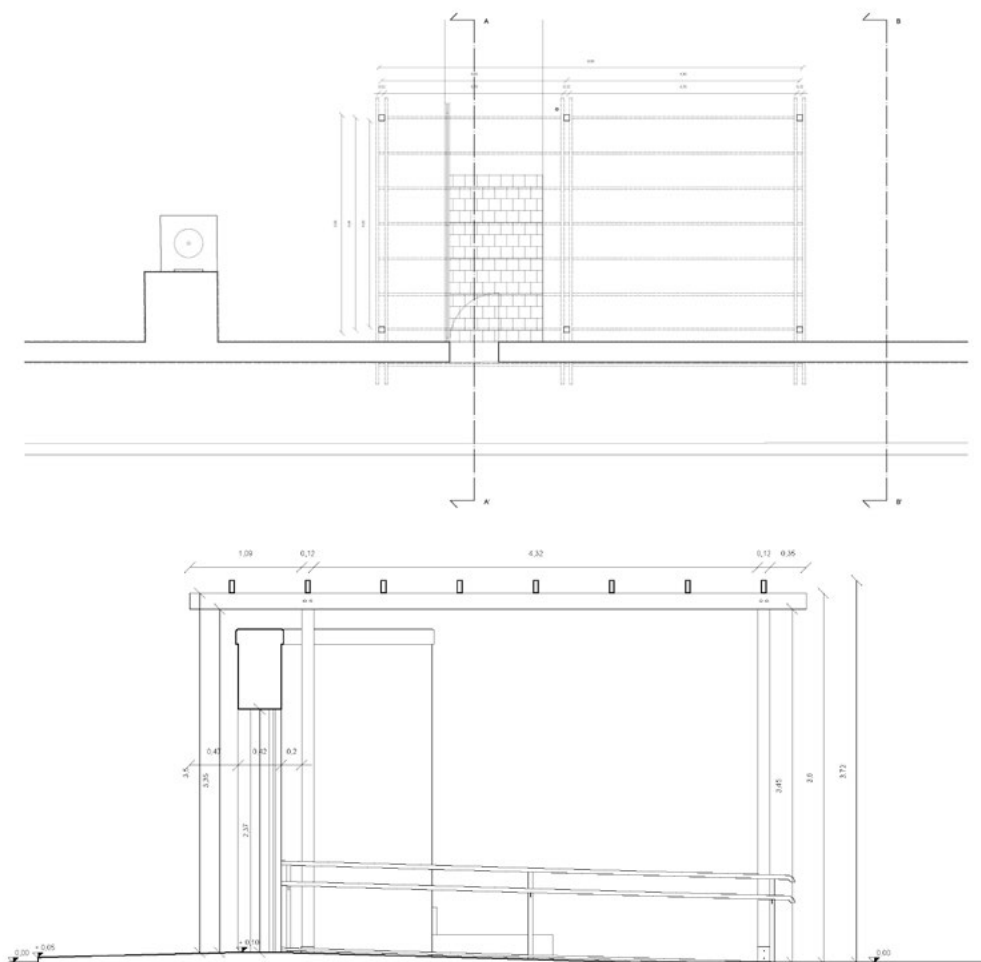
E. Martinelli, progetto della pergola sul muro, 2018. Pianta e sezione.
